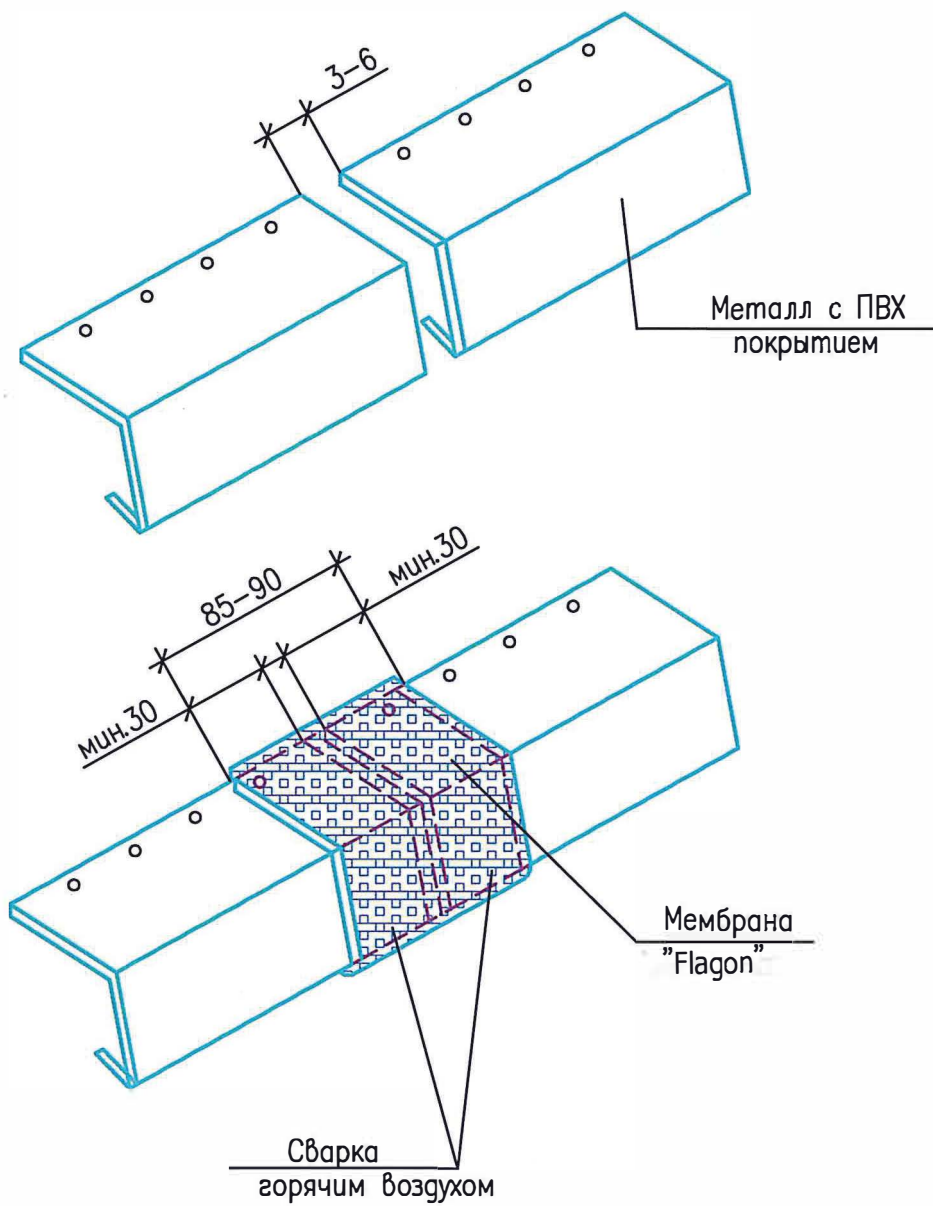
Механическое закрепление к железобетонному основанию. Монтаж мембраны на парапетах и свесах
